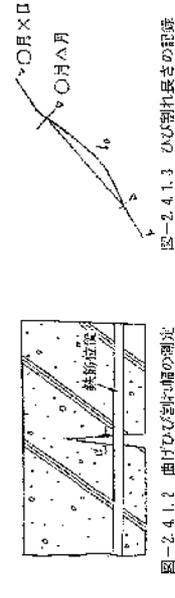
曲げひび割れ幅の測定
